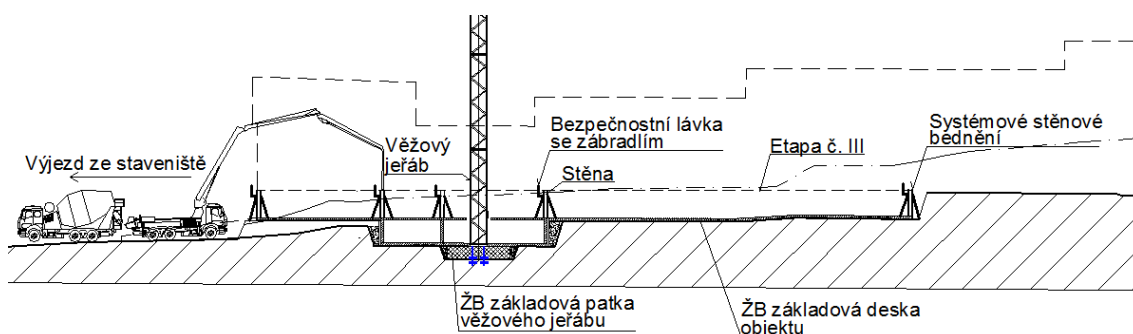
Schéma betonáže základové desky etapy č. III
